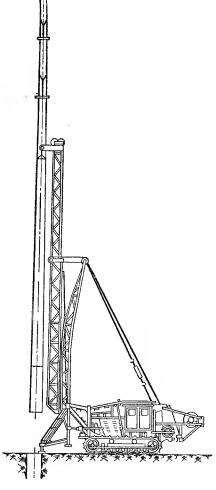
Подъем железобетонной опоры краном КЛЭП-7.
